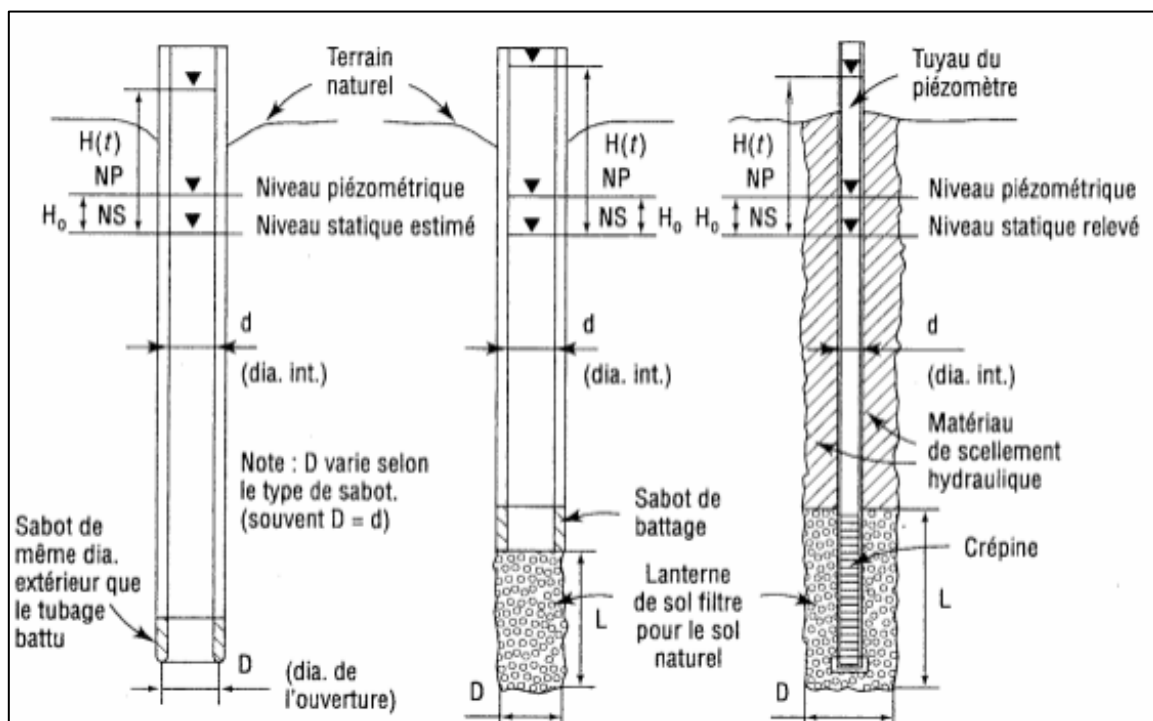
Paramètres géométriques pour l'essai en bout de tubage (a), l'essai de type Lefranc (b) et l'essai dans un piézomètre ou un puits (c) (Chapuis, 1999).
